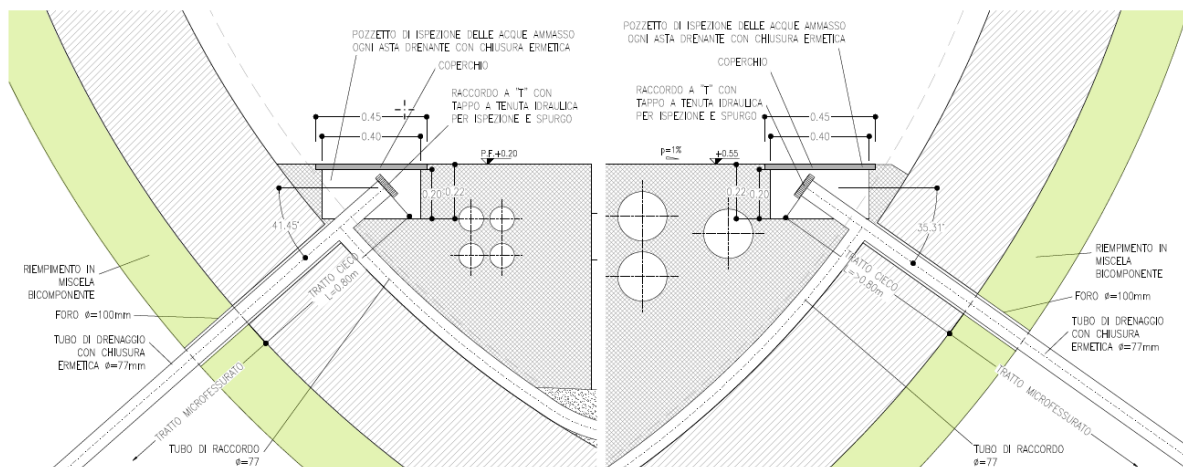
Sistema di drenaggio acque d'ammasso – DR3 – Dettaglio pozzetto di ispezione
